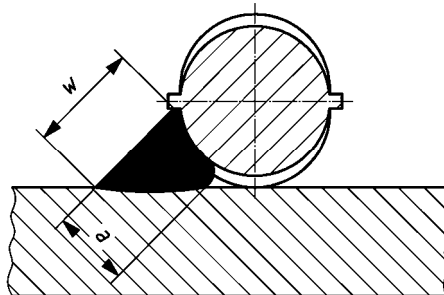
Flankenkehlnähte am gebogenen Betonstahlstab
